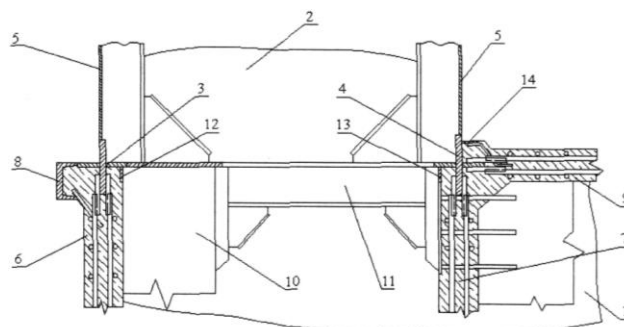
Конструктивный узел соединения металлической башни с железобетонным понтоном
